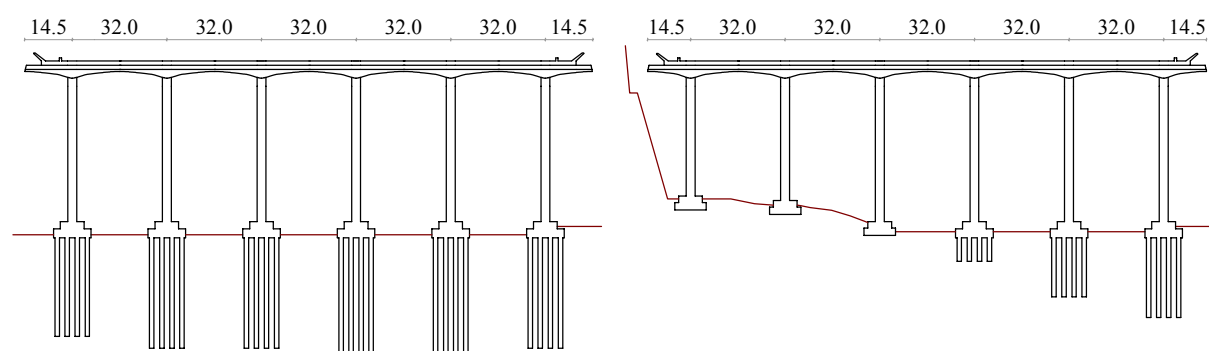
Cortes transversais da estrutura em dois pórticos.
